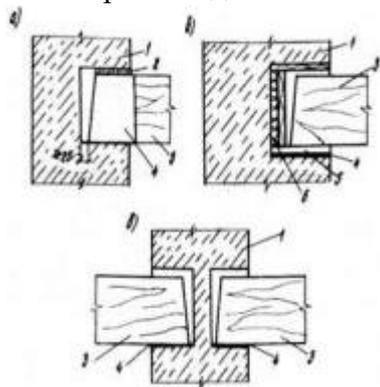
Схемы узлов опирания деревянных балок на стены:
